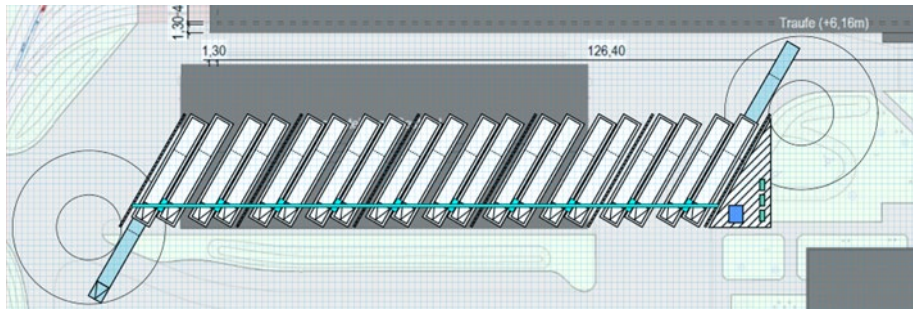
Planausschnitt Neubau Abstellhalle für BEV in Schrägaufstellung
